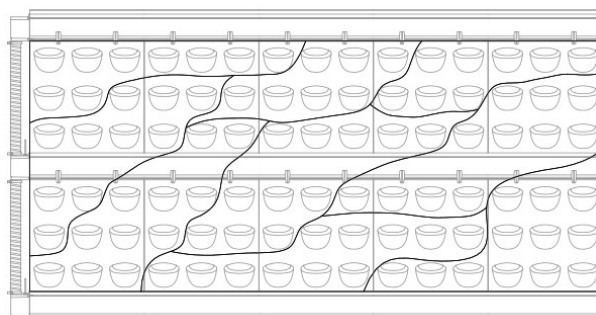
Combinação entre o Plano de Plantação e a Estrutura *LivePanel*® (Fonte: Autor)
